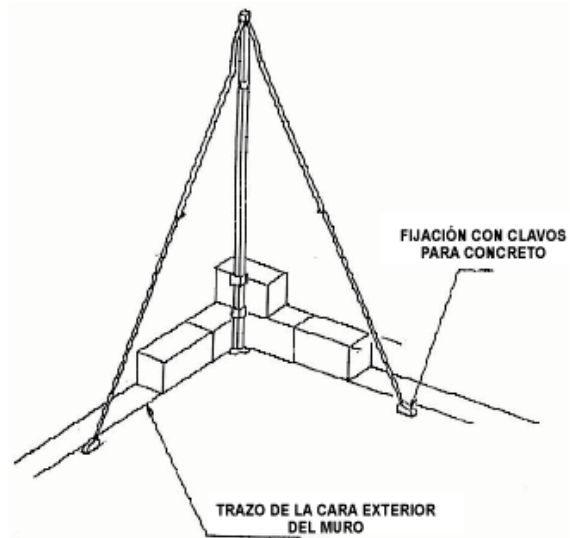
COLOCACIÓN DE REGLA DE ESQUINA SOBRE LOSAS DE PLANTA BAJA EN ESQUINA ENTRANTE
